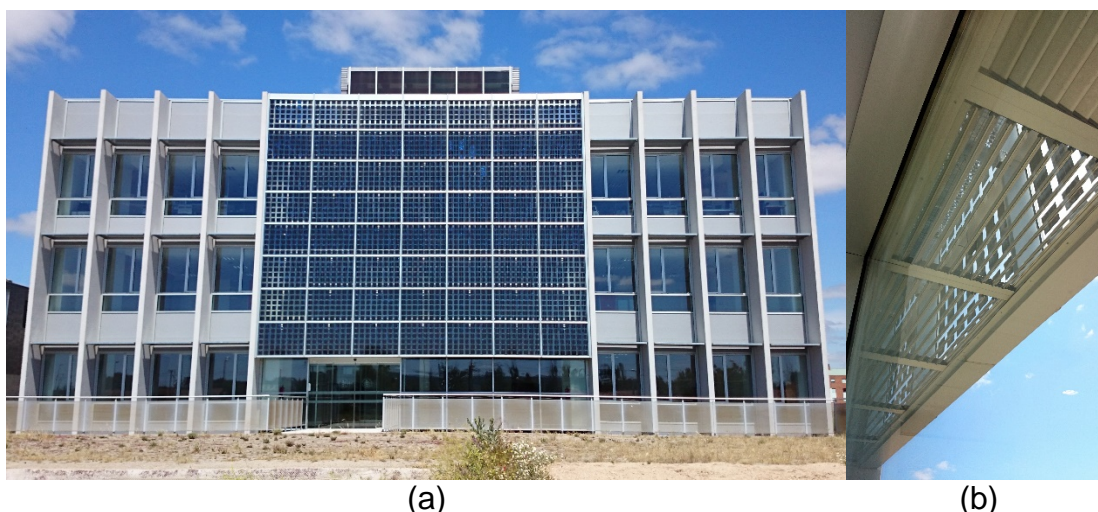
Sistema solar fotovoltaico instalado na Fachada Sudeste do Edifício Lucia. (a) vista frontal (b) detalhe do sistema de ventilação na base da fachada dupla.
